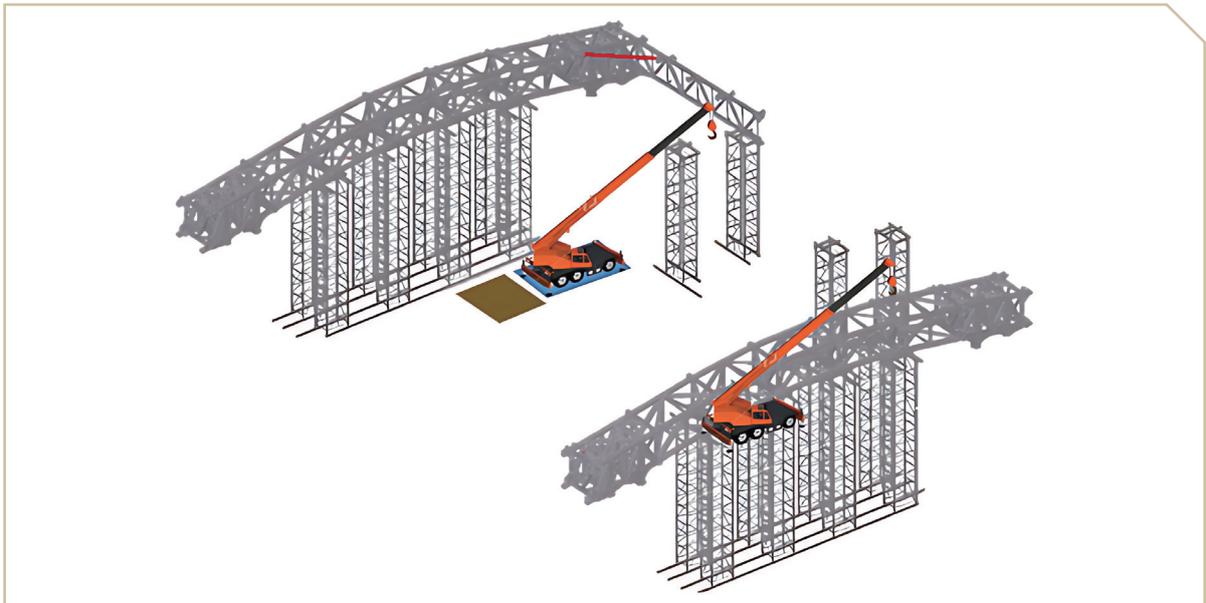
次桁架施工順序圖(3)－安裝臨時水平桿 (Bracing)
